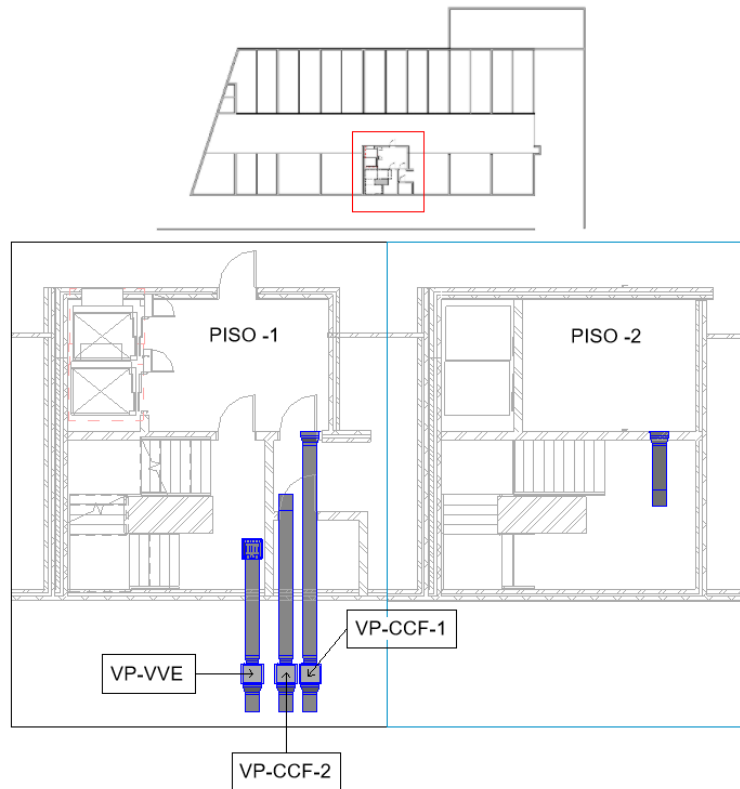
Plantas do Piso -1 e Piso -2 - Detalhe Pressurização
